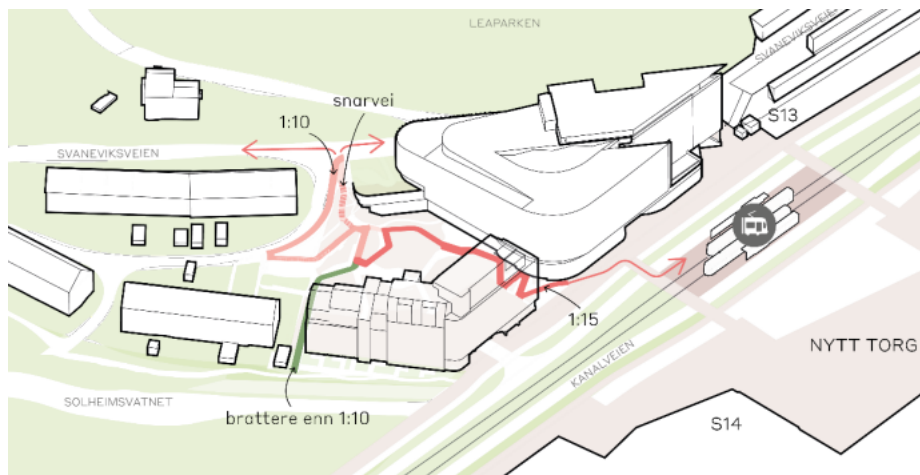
Illustrasjon av hovudgrepa i planforslaget.
